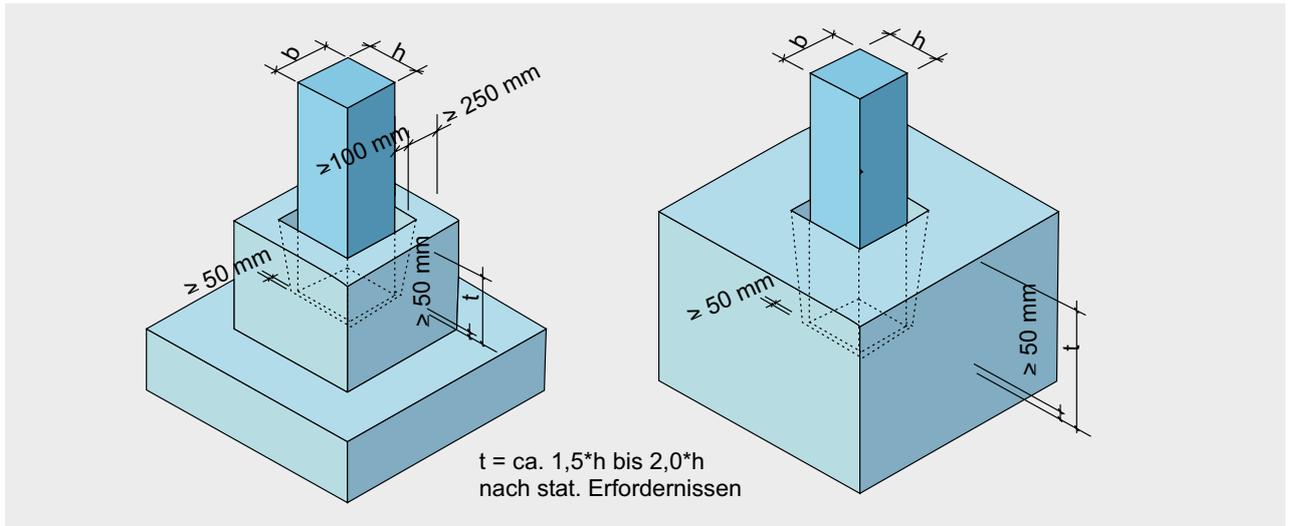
Köcherfundament (oben), Blockfundament (unten)
